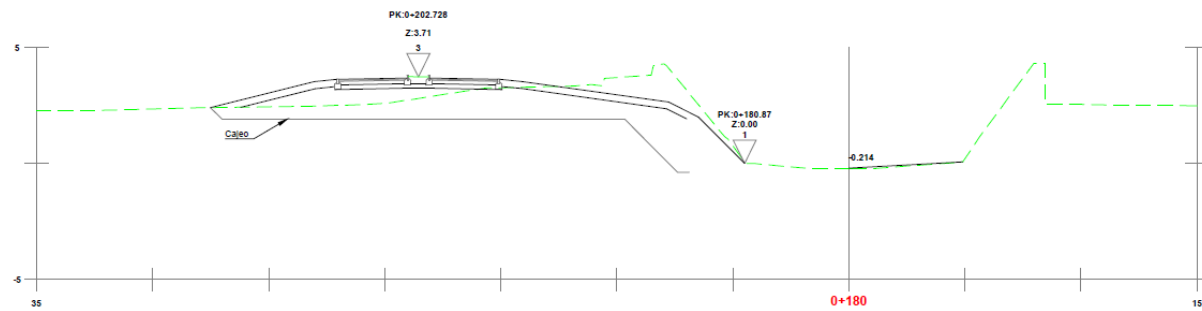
Perfil de las actuaciones propuestas en la zona de encuentro del canal con la ría del Bidasoa, en donde se mantienen los taludes hormigonados de la margen derecha, mientras que en la margen izquierda son sustituidos por taludes de hormigón.
